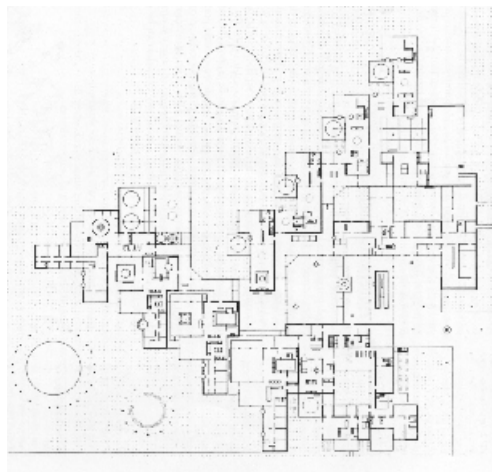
Aldo van Eyck, Orfanato, Amsterdam, 1957-1960. Planta.
